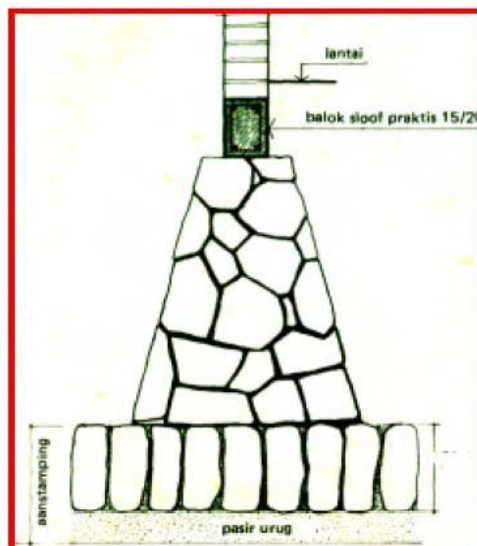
, Batu Kali Sebagai Bahan Konstruksi Pondasi Batu Belah
